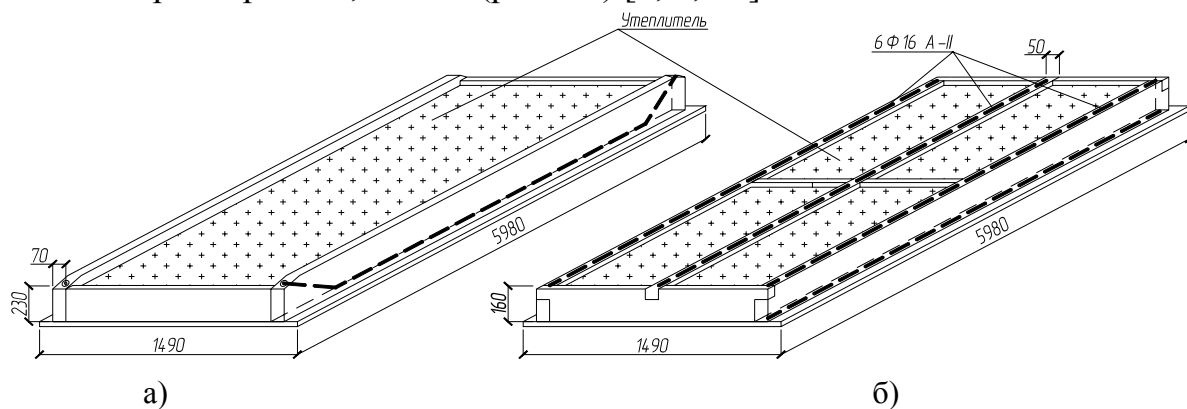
Плиты покрытия с армированным деревянным каркасом и асбестоцементной нижней обшивкой: а – арматура в ребрах плиты с предварительным напряжением; б – ребра плиты армированы без предварительного напряжения
